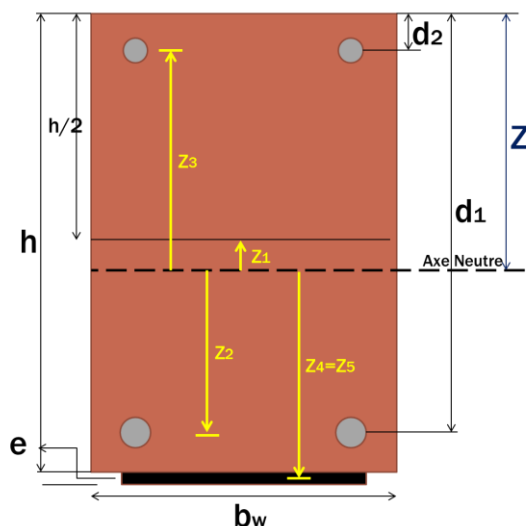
Axe Neutre de la section de la poutre non fissurée
